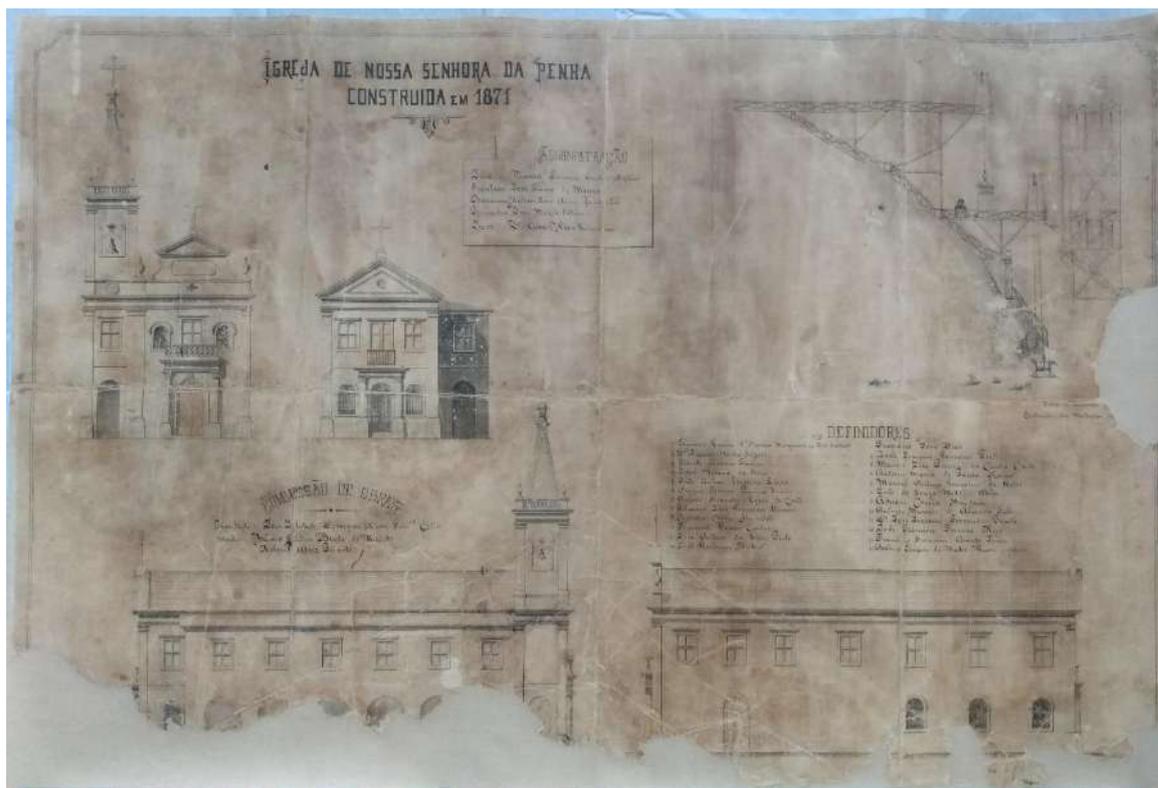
Planta recentemente restaurada da reforma pela qual a Igreja da Penha passou em 1870.
